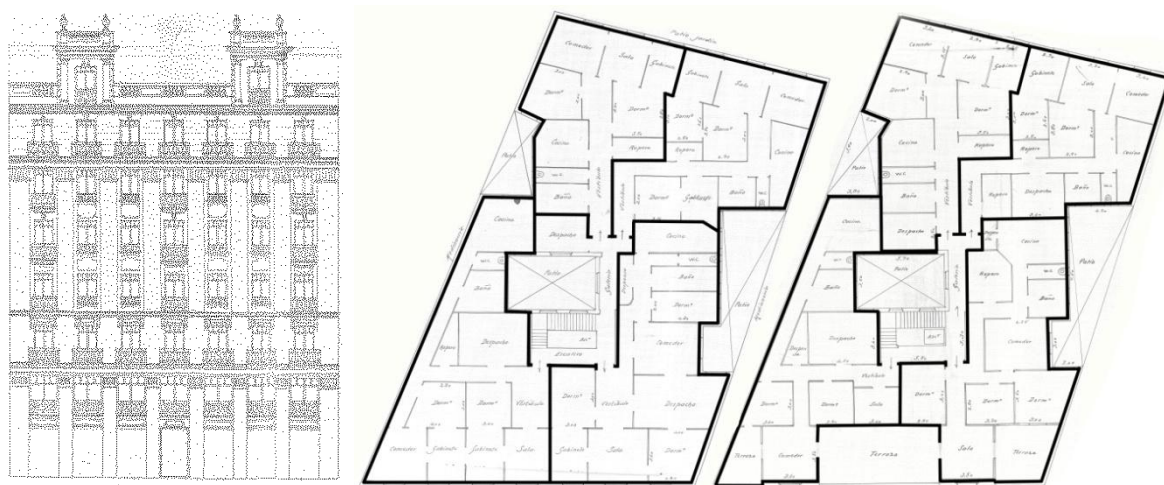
Planos de la fachada, de las plantas de pisos del entresuelo al 4º y del ático del inmueble nº 15 de la Avenida Menéndez Pelayo presentados en 1926. Escala 1:100. AVM, Secretaría, 25-260-7.
